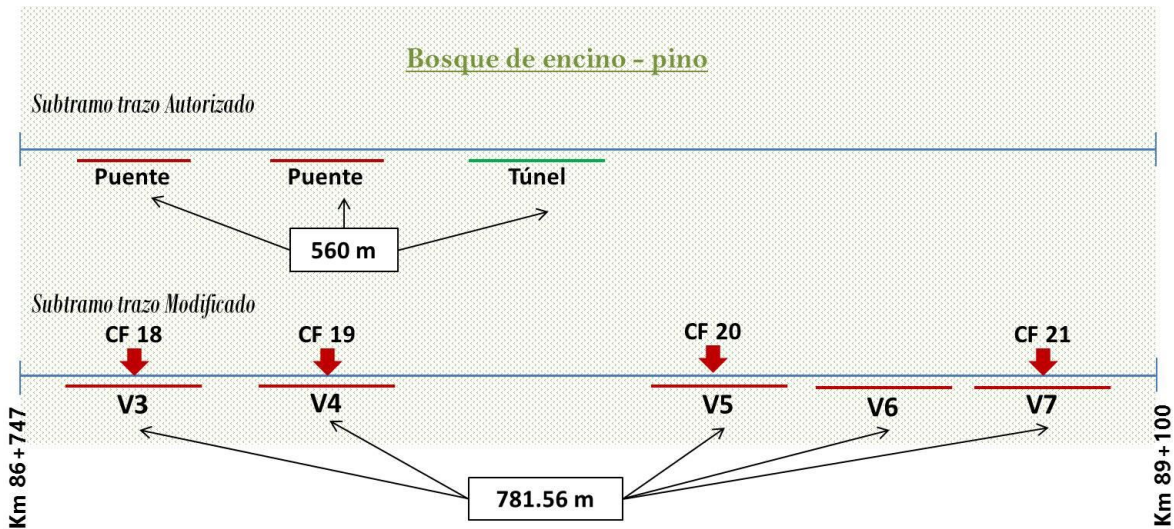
Representación fuera de escala de la distribución de estructuras del proyecto autorizado comparado con la modificación 8 subtramo km 86+747 al km 89+100).
